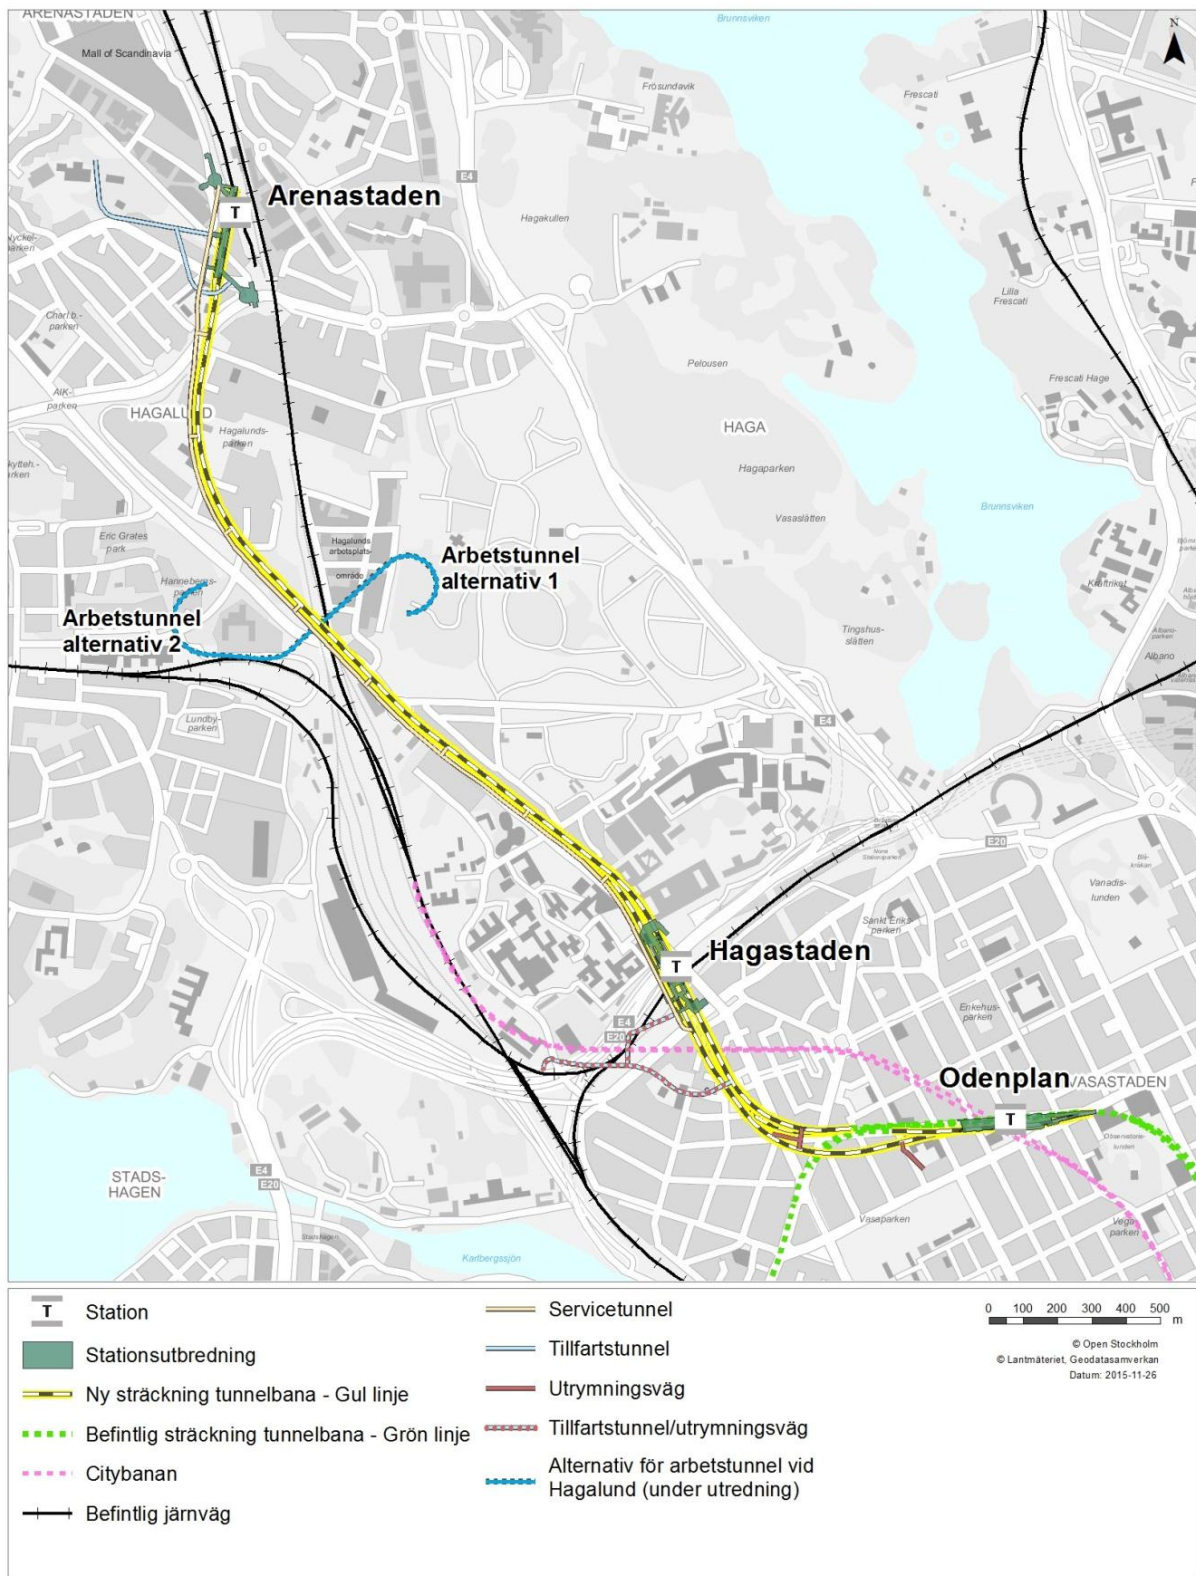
Tunnelbanans sträckning mellan Odenplan och Hagastaden.
